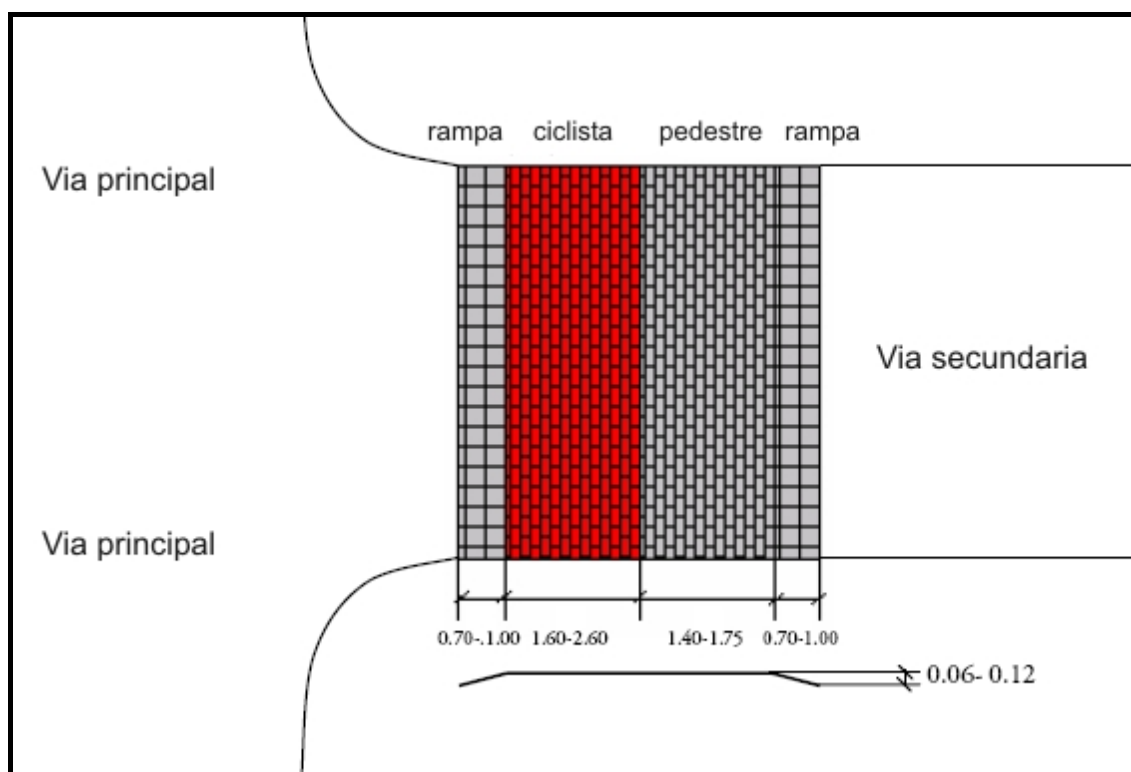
Esquemático de cruzamento cicloviário elevado, com pavimento diferenciado.
